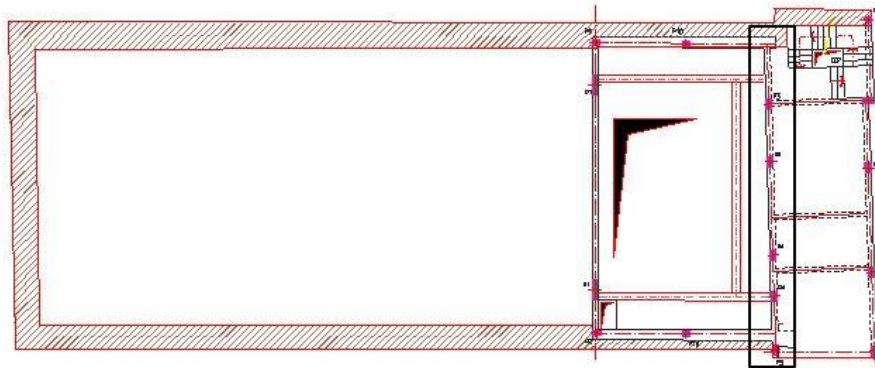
Identificação da viga V5.2 analisada na planta à cota +5,68
